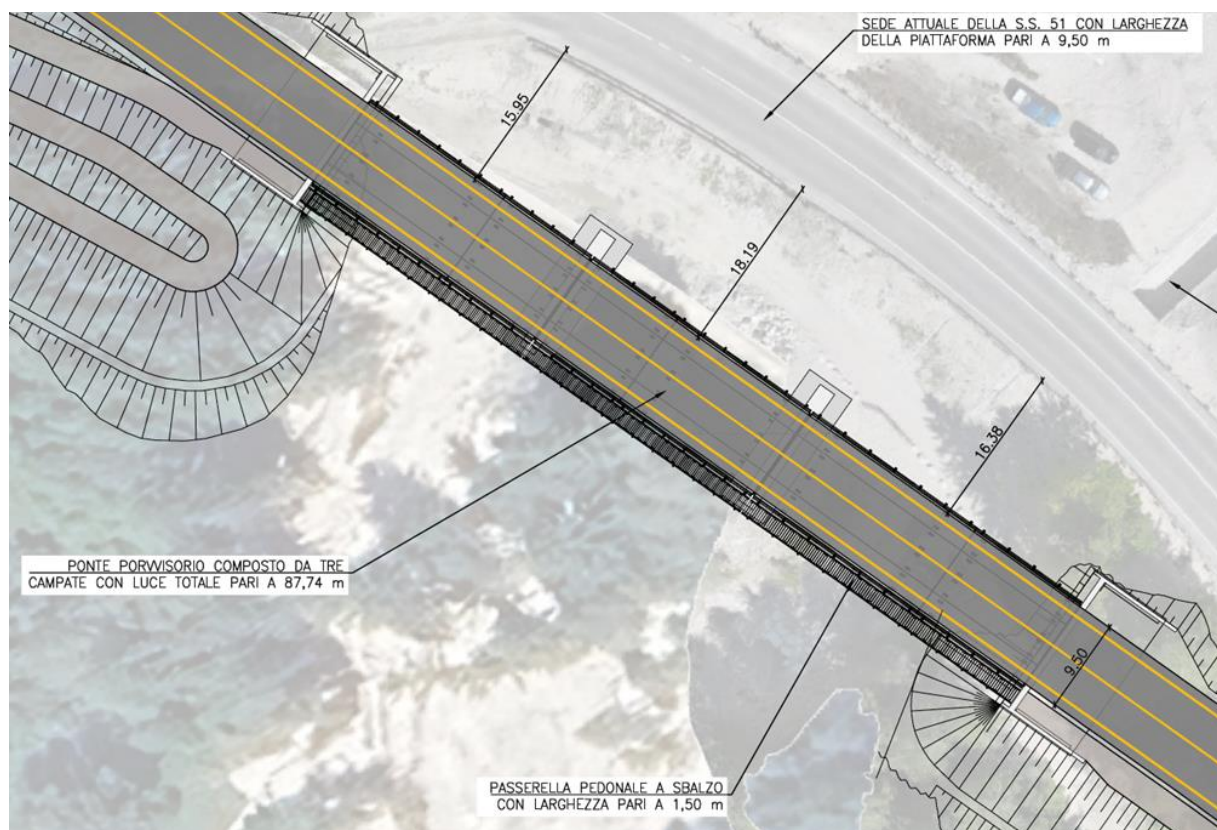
Disposizione passerella pedonale a lato ponte con rampe di accesso
